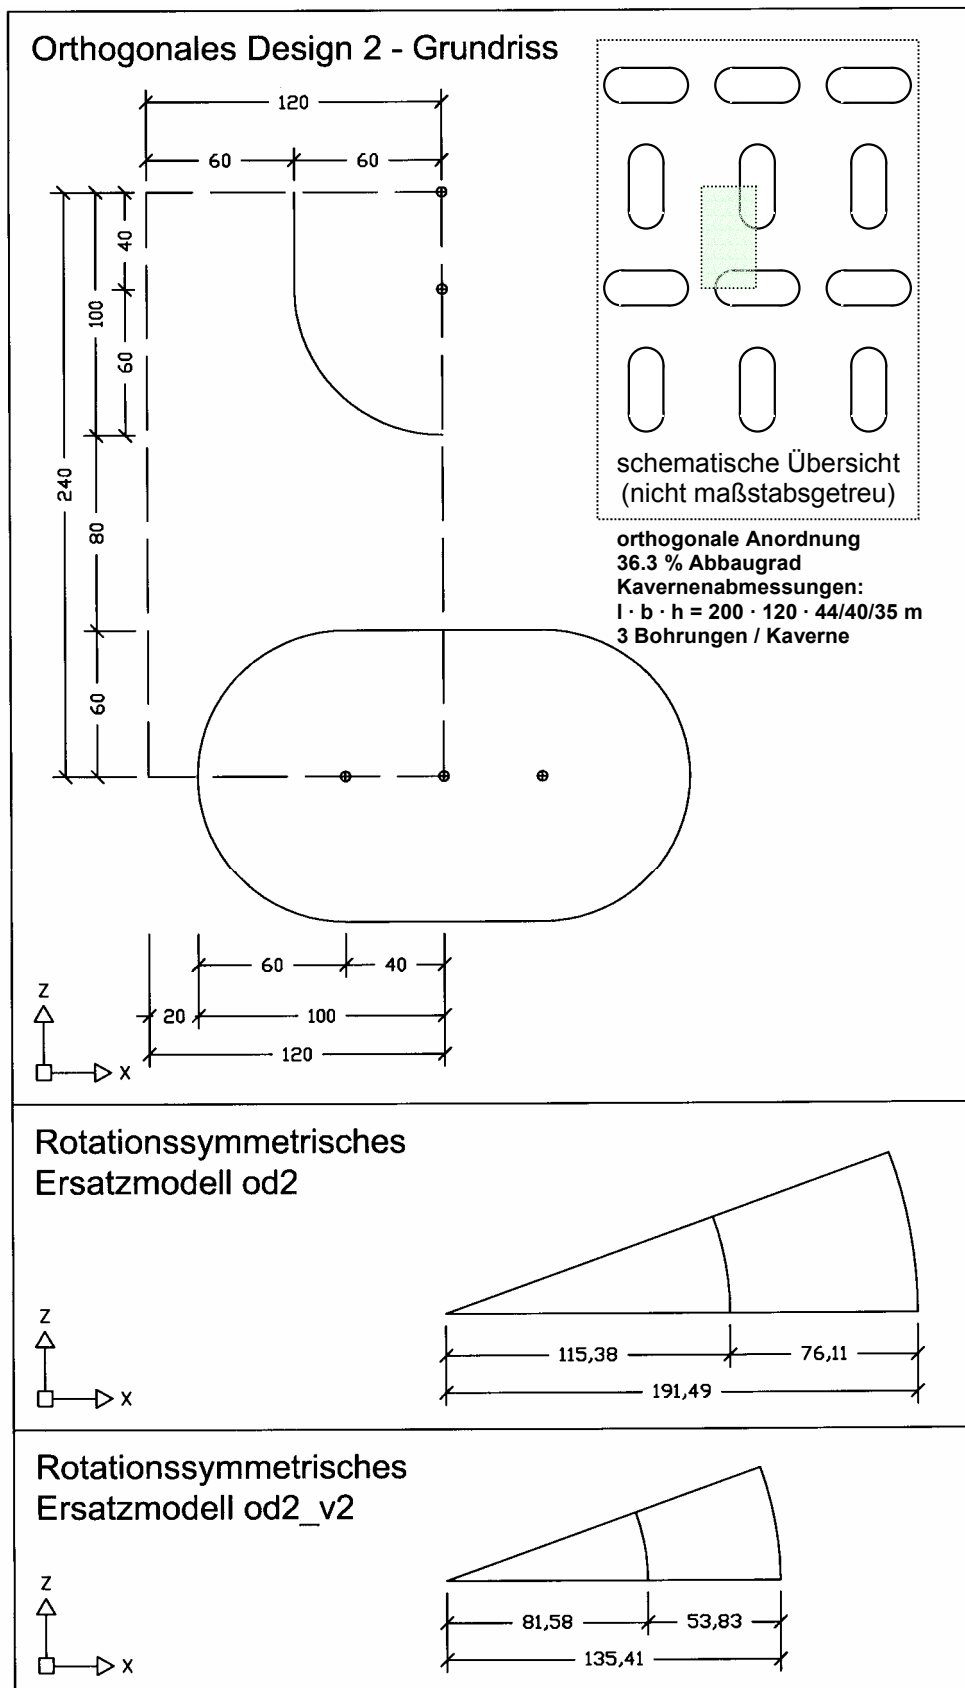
Orthogonales Design 2 – Grundriss und rotationssymmetrische Ersatzmodelle
